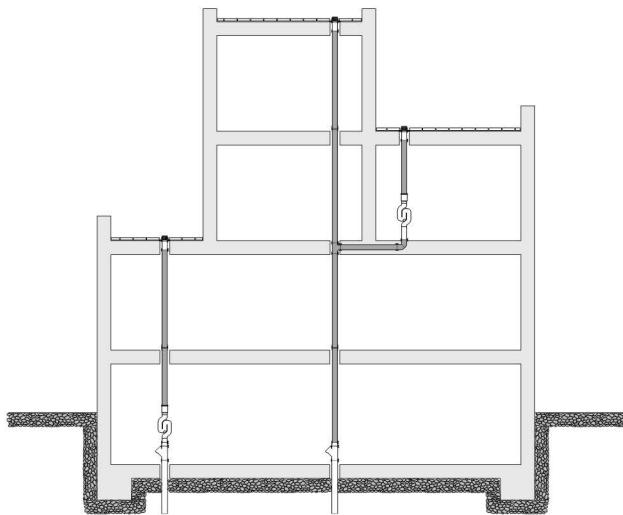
Innenliegende Dachwasserfallleitungen mit Geruchsverschluss
